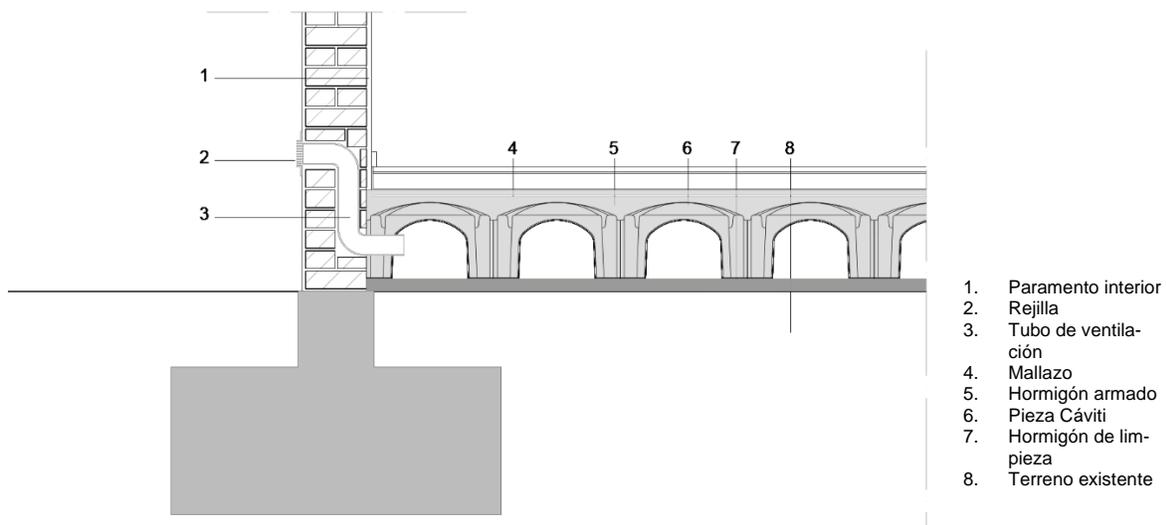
Detalle sistema Cáviti ventilación forjado sanitario.
